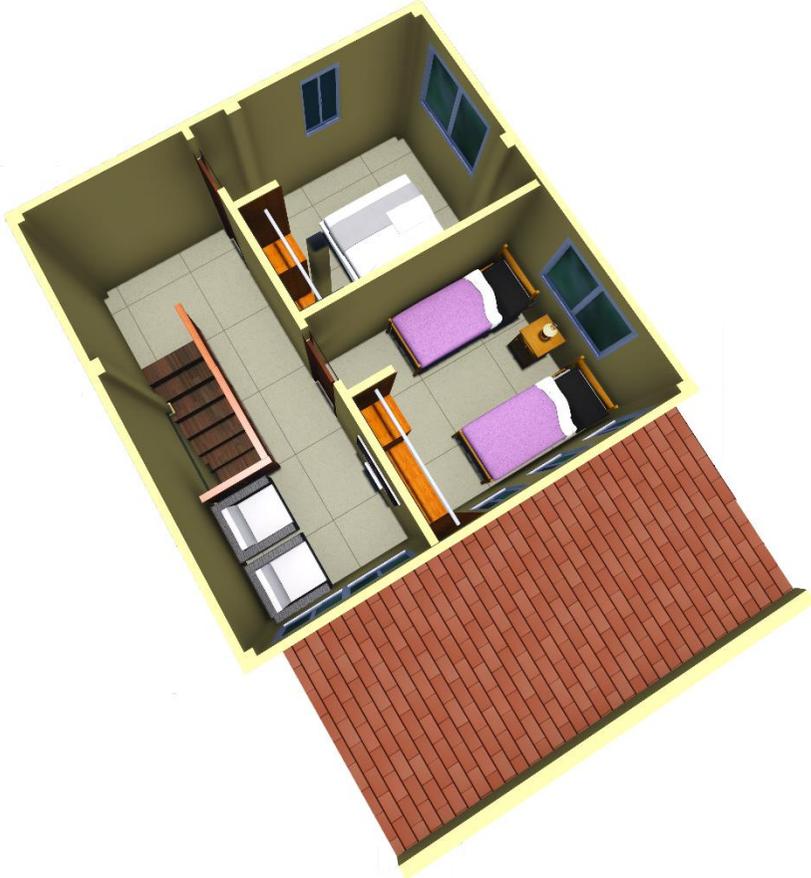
Vivienda Tipo 3 Planta Baja Ampliada
